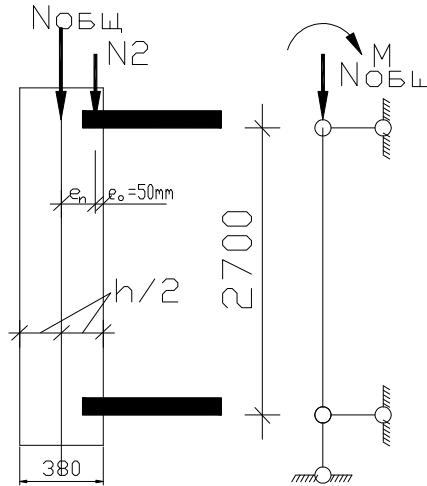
Расчетная схема каменного простенка 1-го этажа
